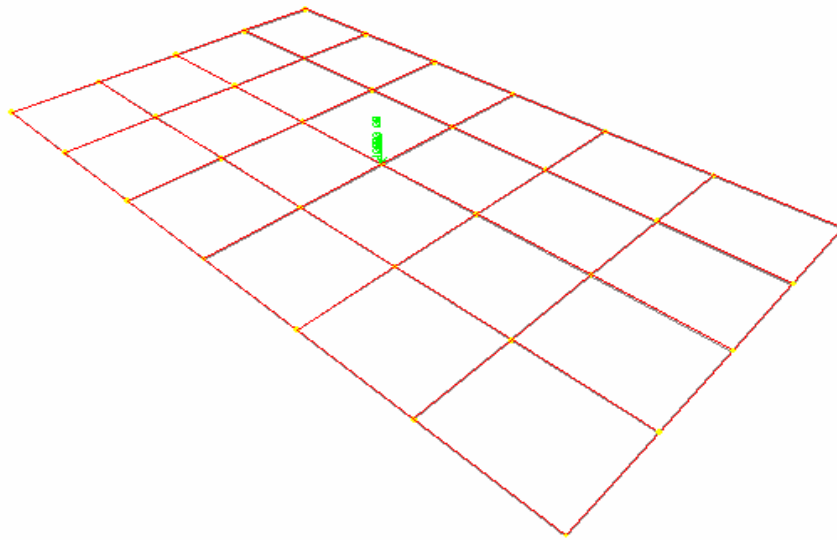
Pemodelan Pembebanan Konfigurasi Empat Beban T = 10 ton
